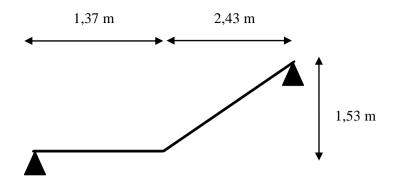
Schéma d'escalier type 2 niveau RDC et EC.
